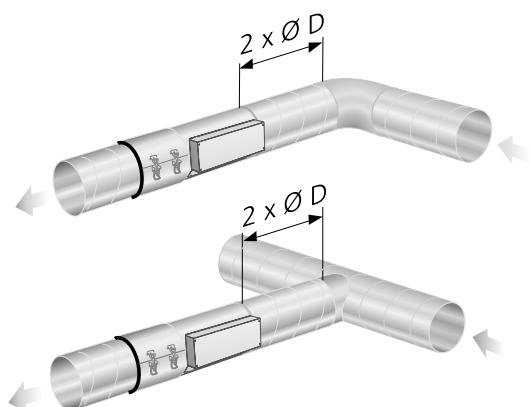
Прямой участок воздуховода круглого сечения перед устройством
